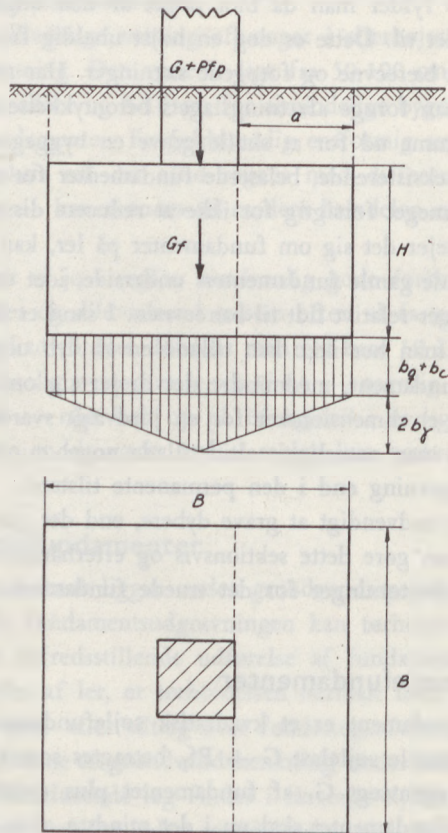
Uarmeret, kvadratisk søjlefundament.
